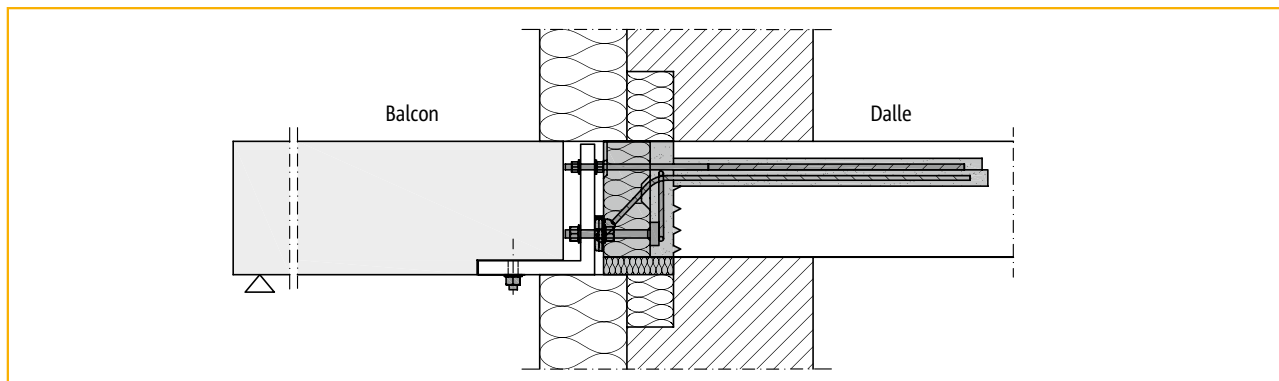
montage d'un balcon préfabriqué sur une dalle existante avec modèle RKS10, construction soutenue
